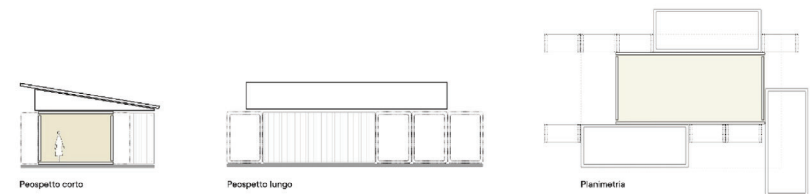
Rural kit prototype Pau. Foto-inserimento, pianta e prospetti.
